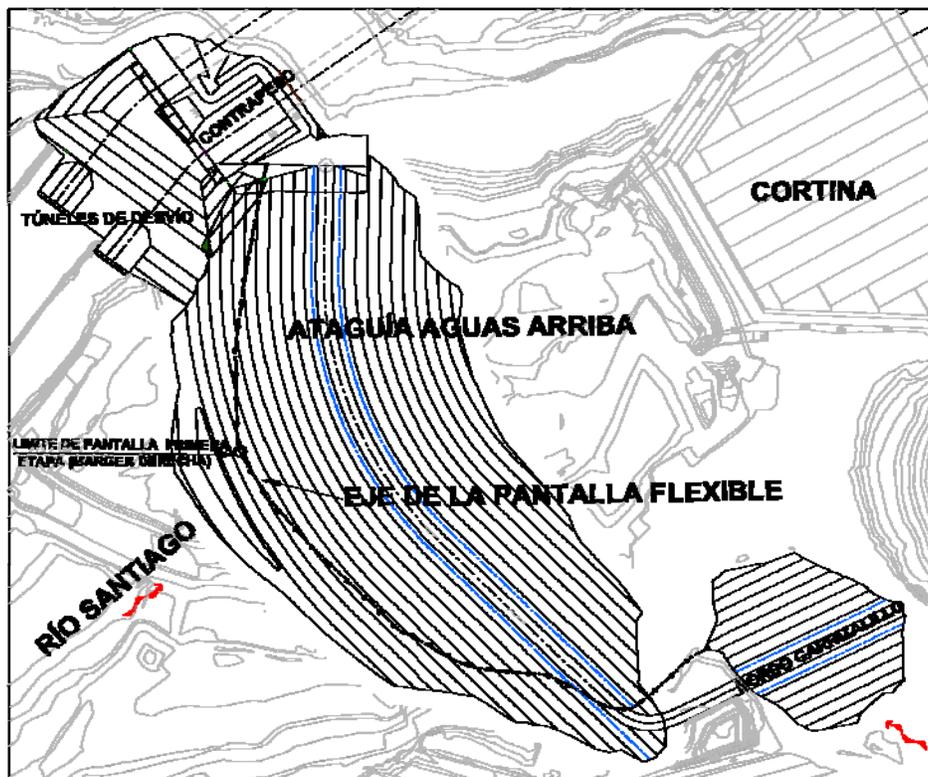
Vista en planta de la ataguía aguas arriba – Pantalla Flexible
